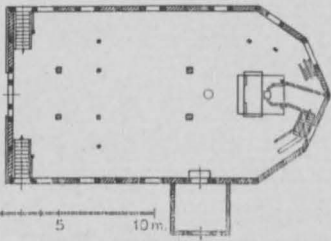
Schönwalde (Spreew.). Grundriß der Kirche.
